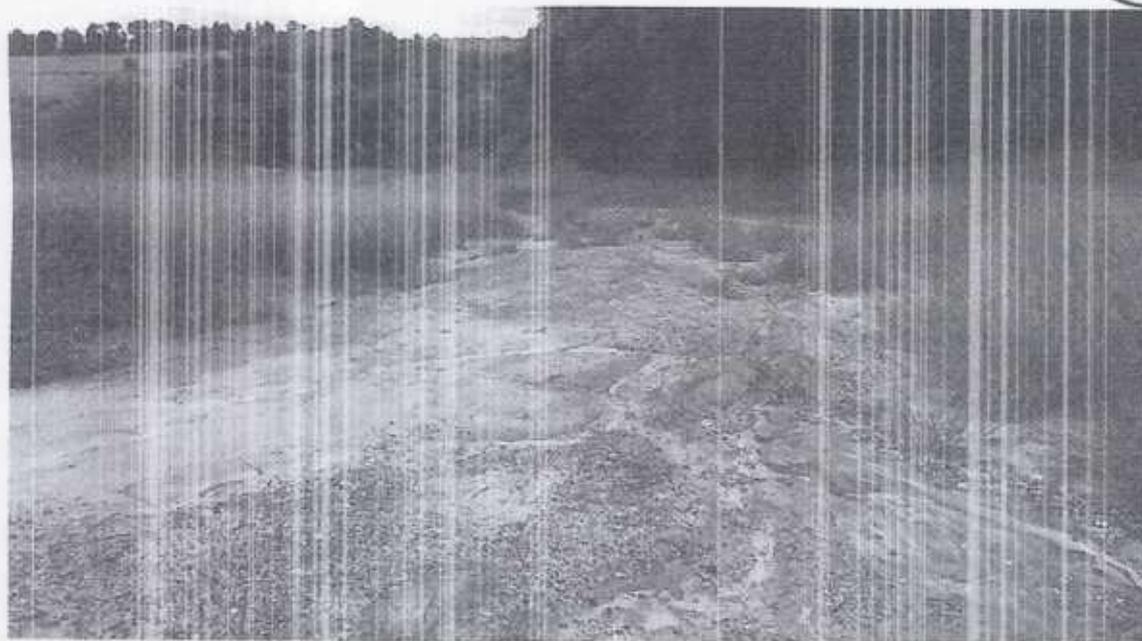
Rua 04 - Sem demarcação da via, sem execução das guias e pavimento.
